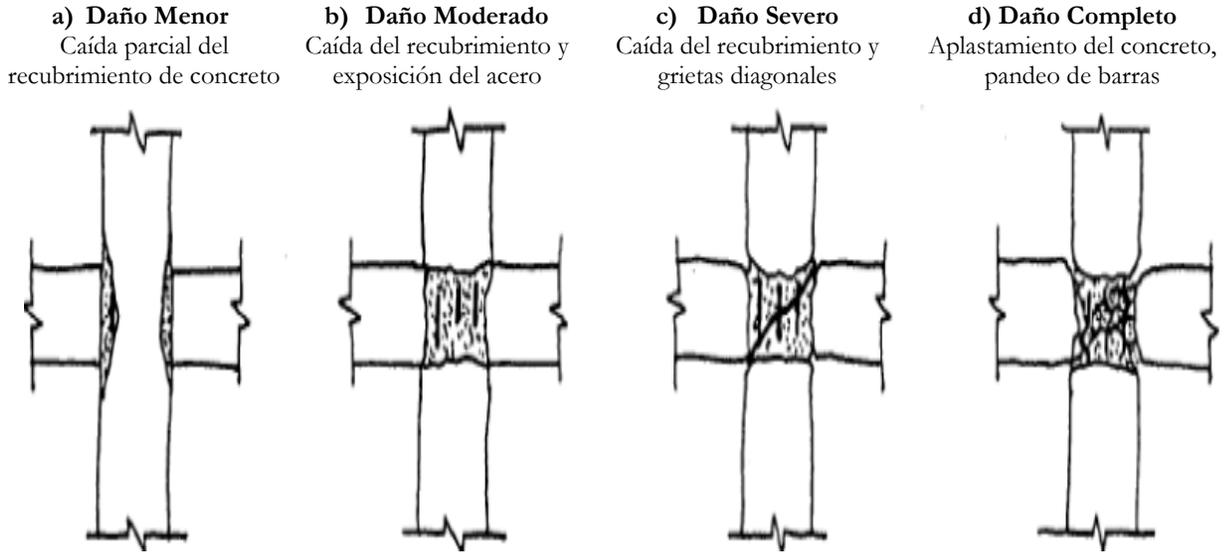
Daños en juntas (nodos) de concreto armado. Adaptado de Kaminosono et al., 2002.
